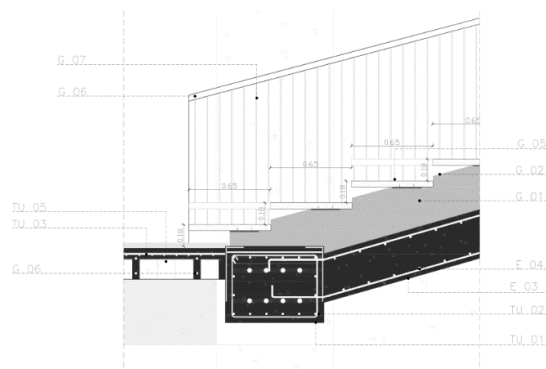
Detalle de la intervención en la rampa preexistente para grada metálica. 2022 (Fuente Propia)
